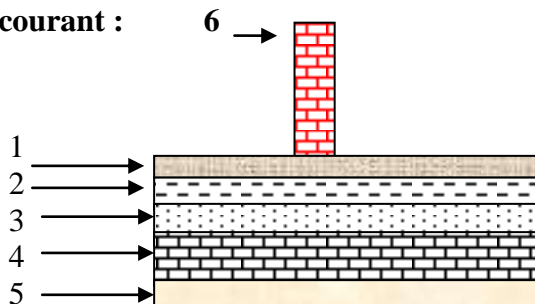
Coupe verticale d'un plancher des étages courant.
